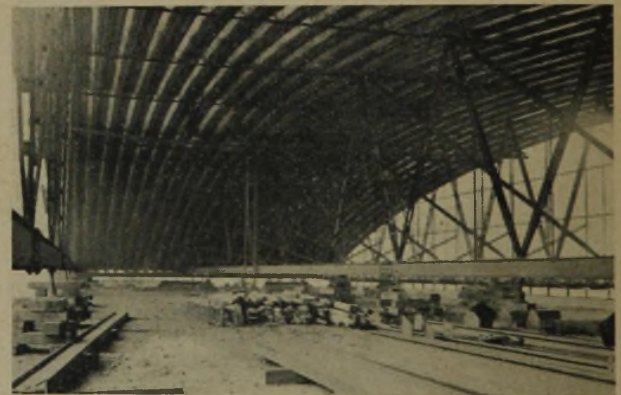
Hallenleichtbaukonstruktion, System Krupp
